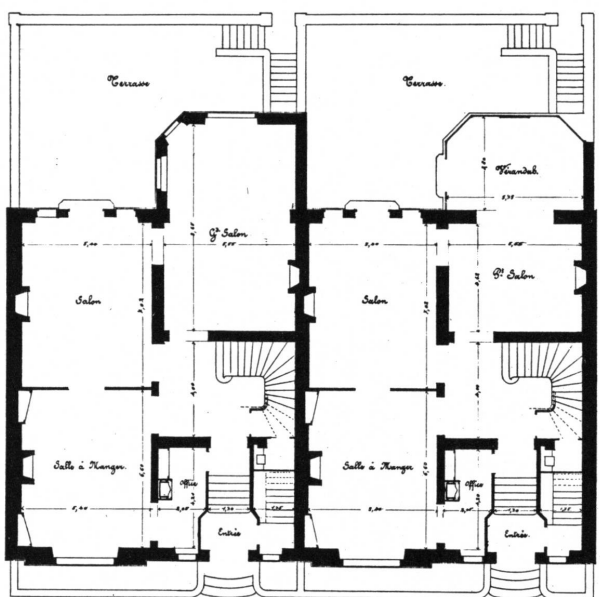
Rue Emilie-Gourd n°s 10 et 12. Plan du rez-de-chaussée.
